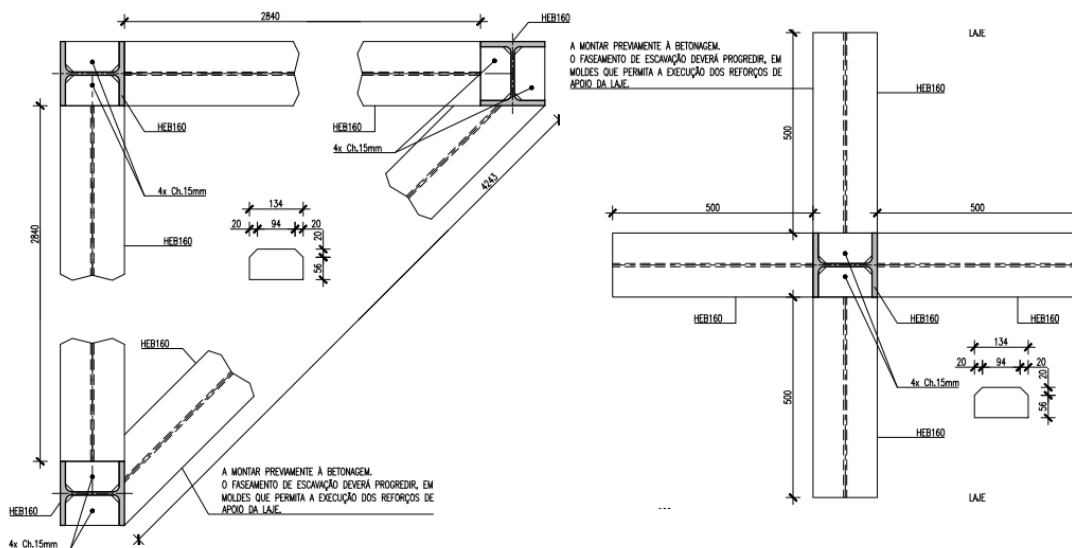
Reforço das lajes na zona de descarga de terras e Reforço inferior. [Fonte: Projeto ECP]
